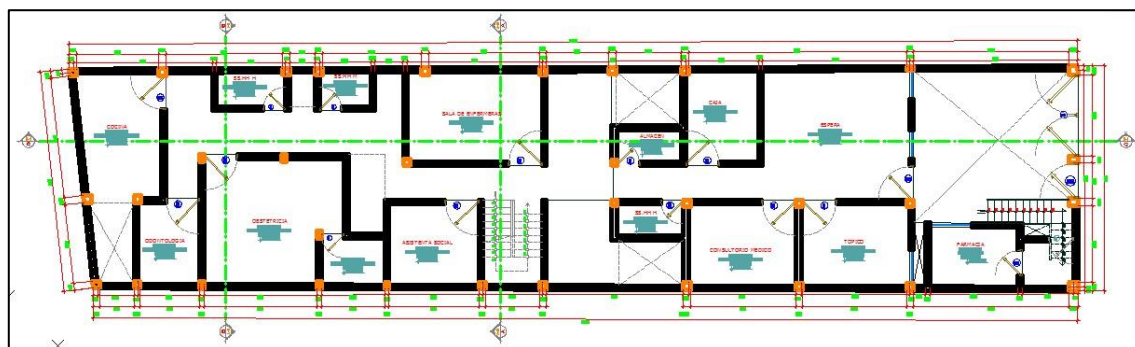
Croquis de la planta general existente del Puesto de salud-Caleta Carquin
